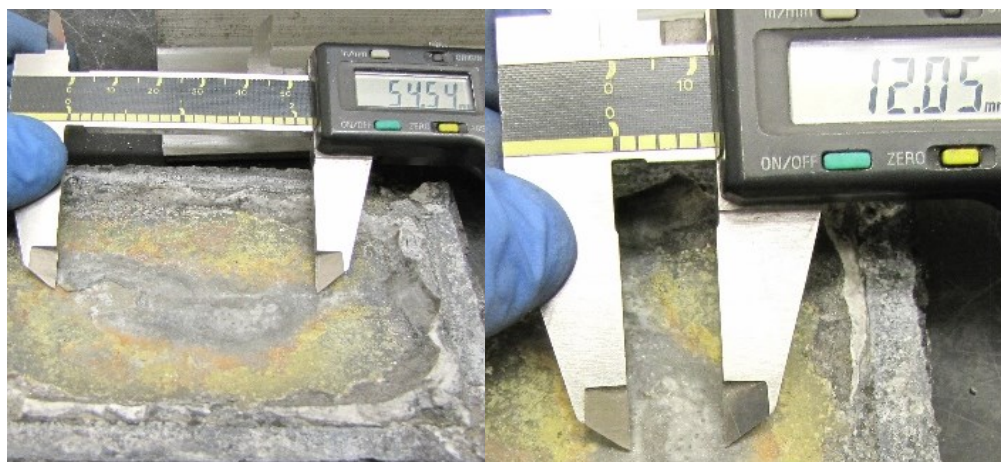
Mesure des dimensions d'une boue typique; toutes les dimensions sont en mm.
